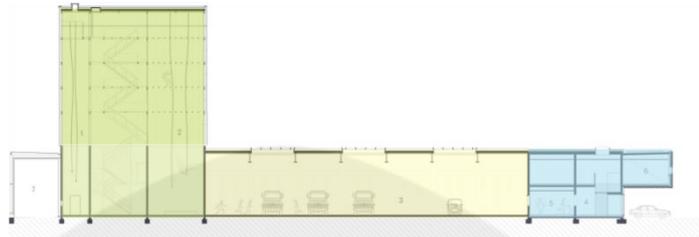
23 Pembagian Zona pada Denah Lantai 1
